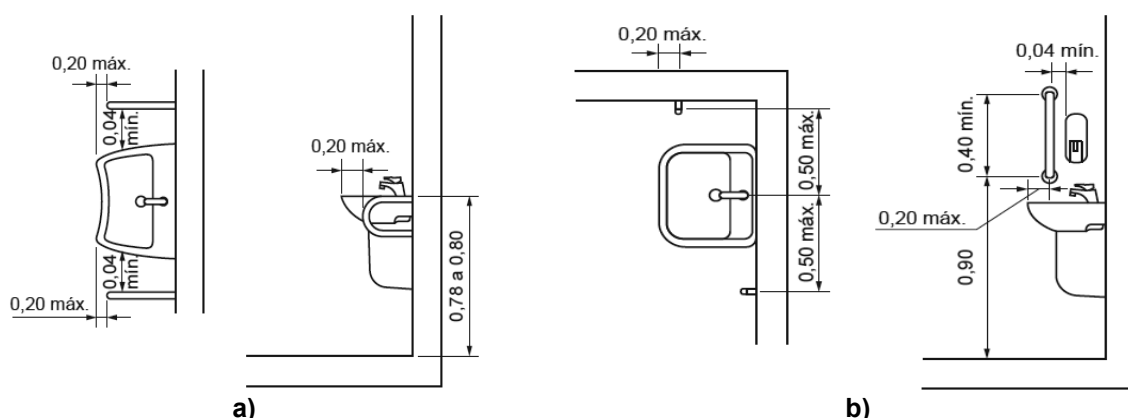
a) Barras horizontais de apoio; b) Barras verticais de apoio
